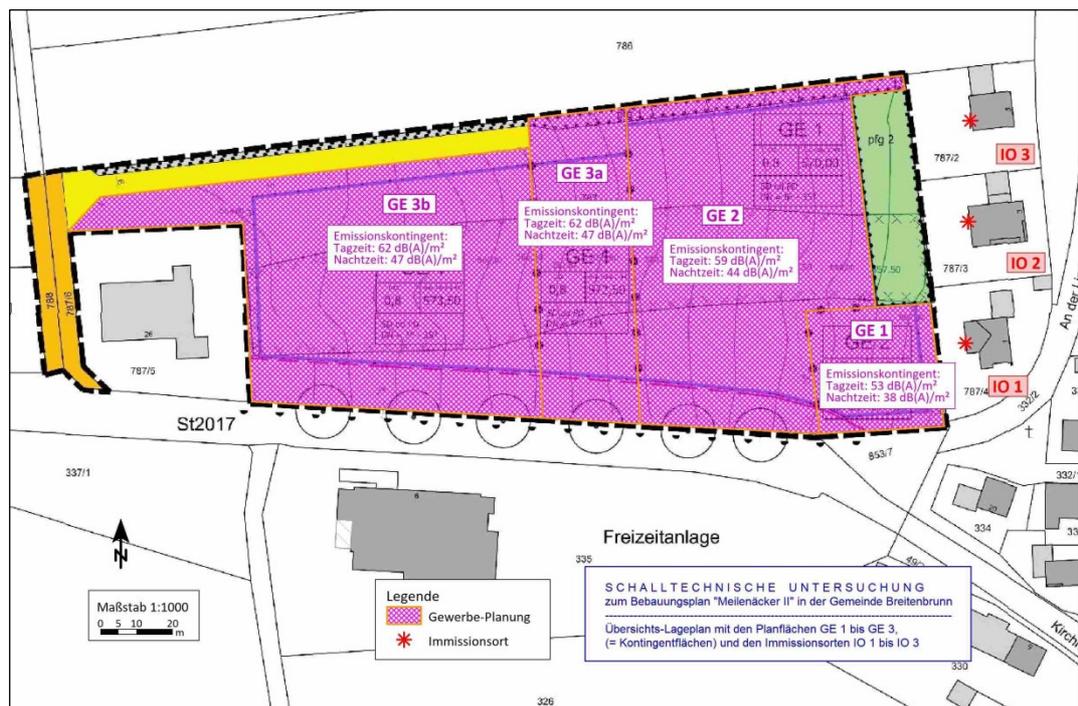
Textabbildung Lageplan Anhang 1.1 (ohne Maßstab)
